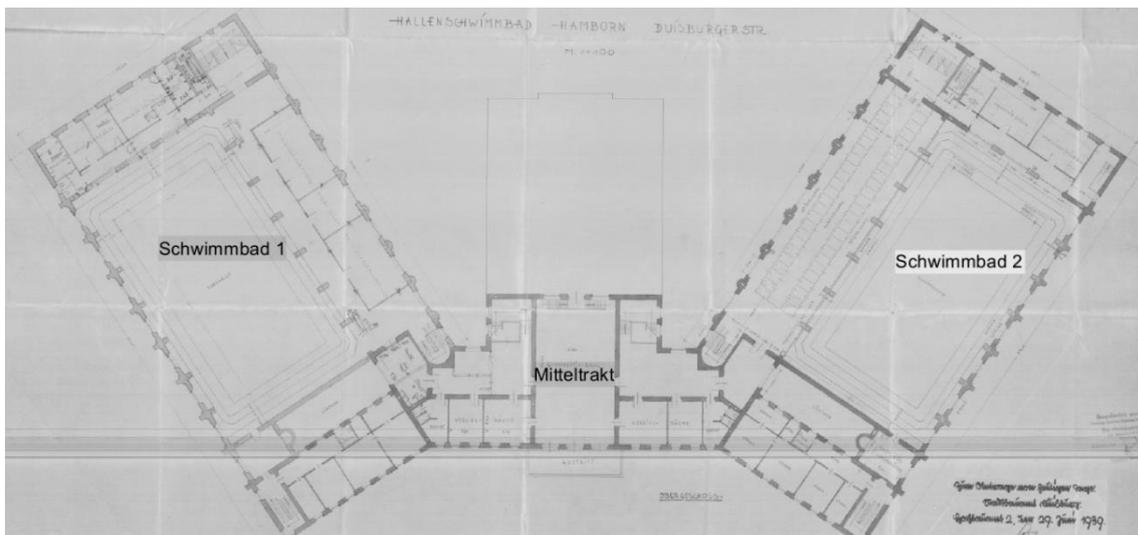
Grundriss Bestand [Triade Architekten]
